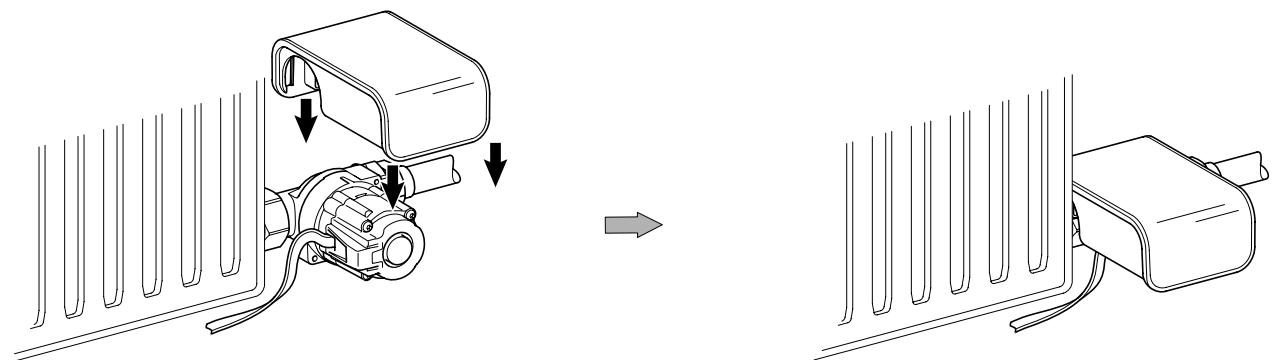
GeniAx Design Abdeckung M für Pumpe/Adapter Set Für Verteiler (Rücklaufadapter)
